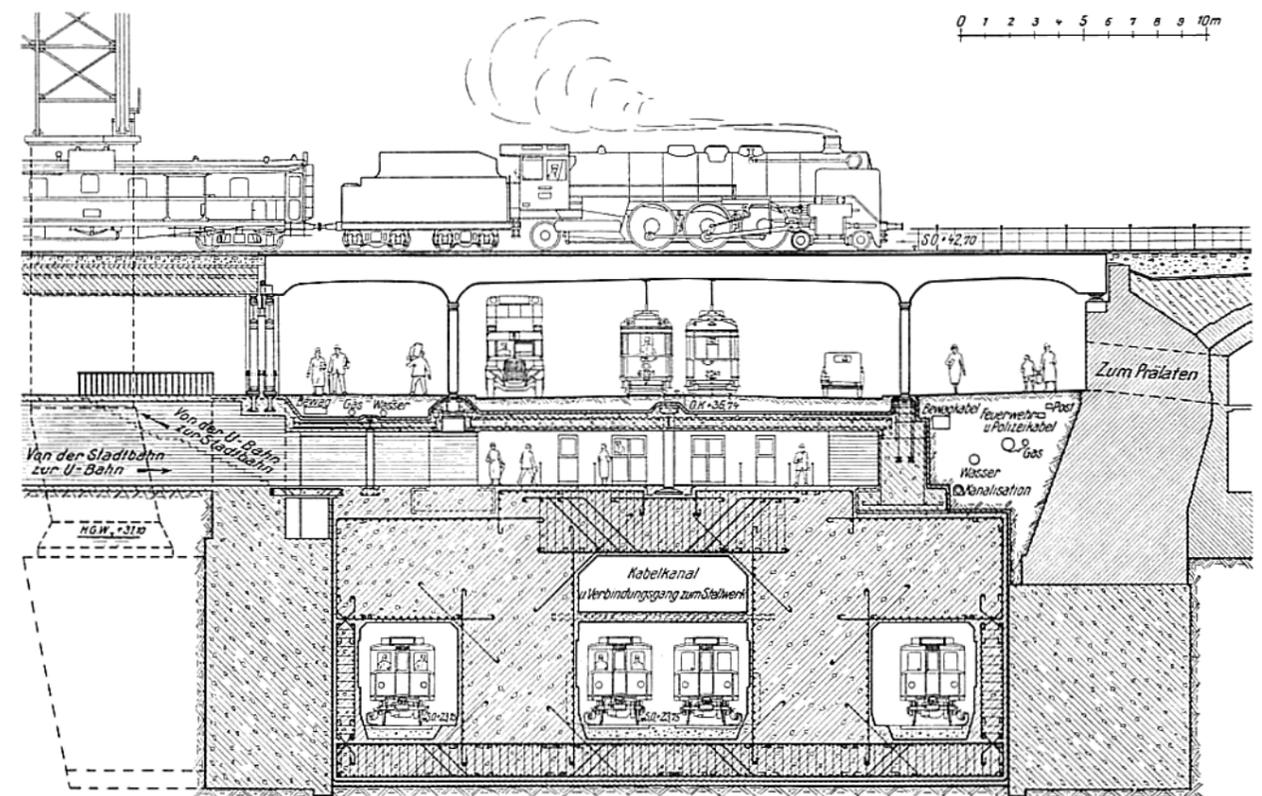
Stadtbahnüberführung in der Königstraße. Querschnitt durch das fertige Tunnelbauwerk.
